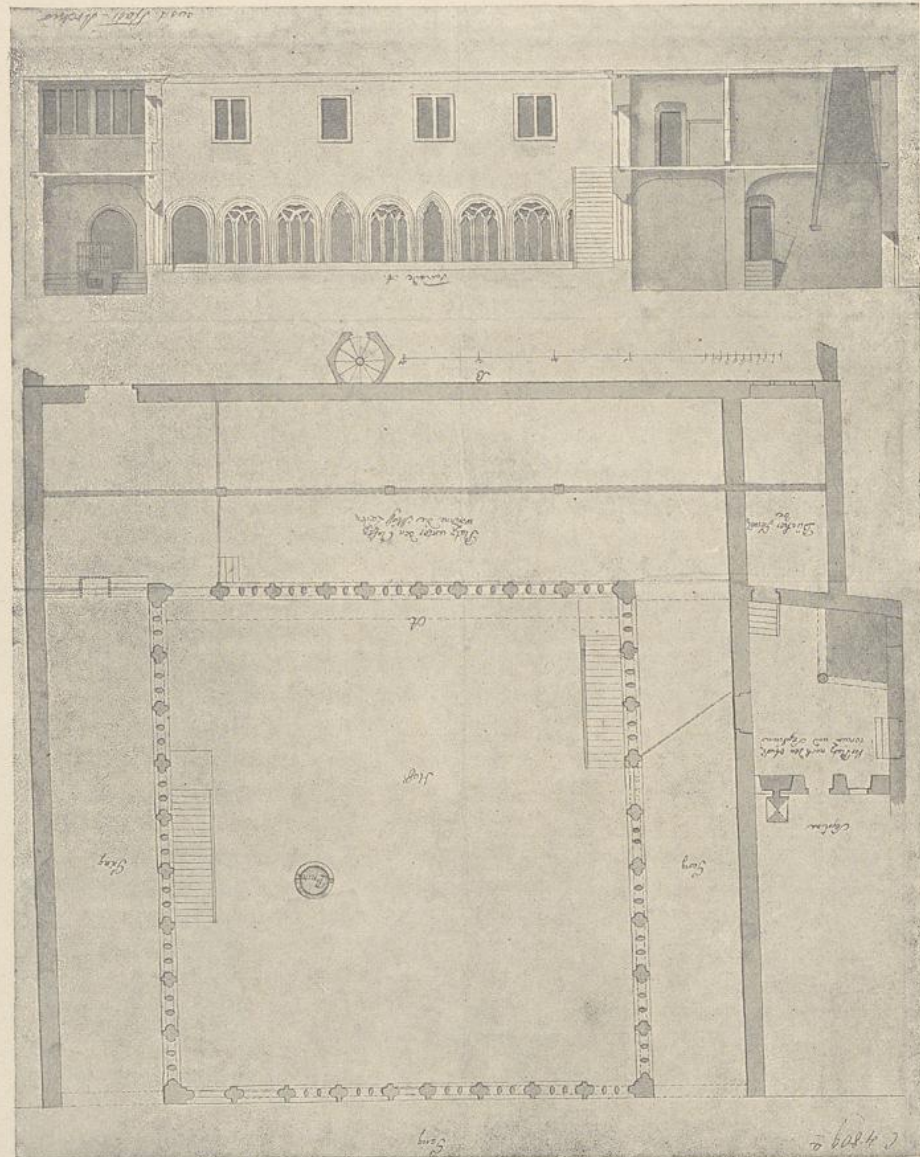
281. Ehemaliges Barfüsser-Kloster; Grundriss und Schnitt des Kreuzganges.
